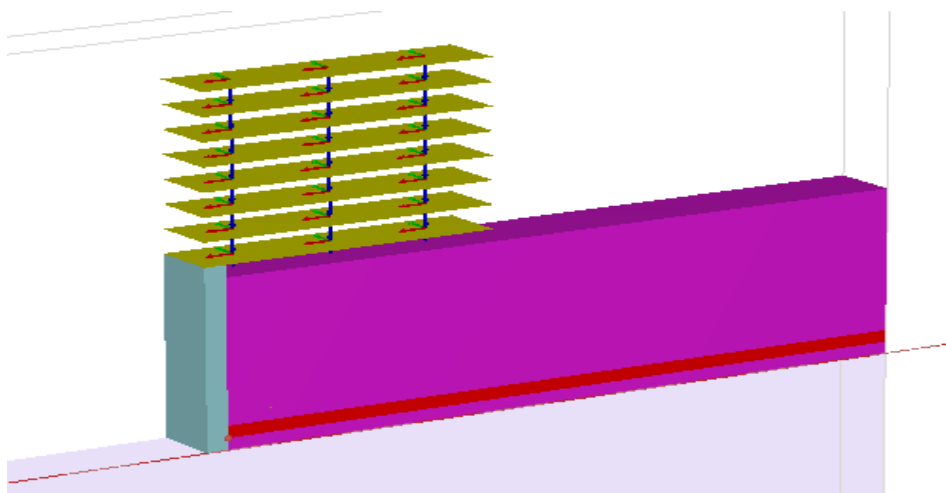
Étape intermédiaire: après la mise en place des couches de remblai et des nappes de géogrille.
